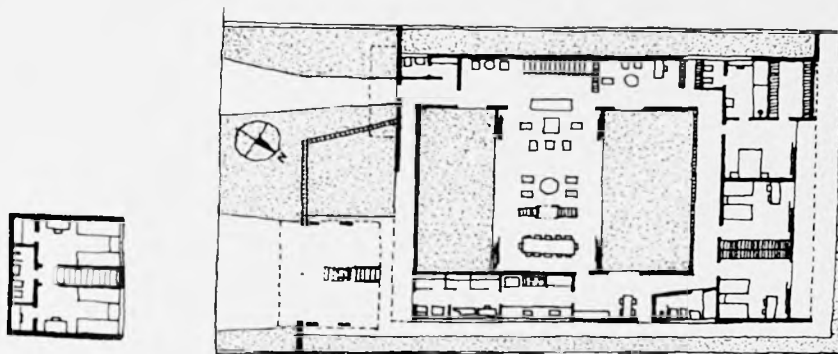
e 479 Croquis plantas baixas casa Castor Delgado Perez.
